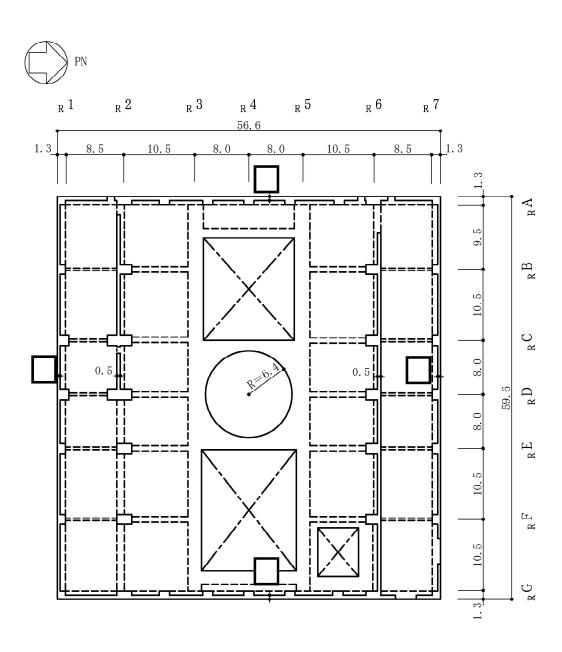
原子炉建屋の概略平面図 (4F, T.M.S.L.31.7m) (7/9) (単位:m)
